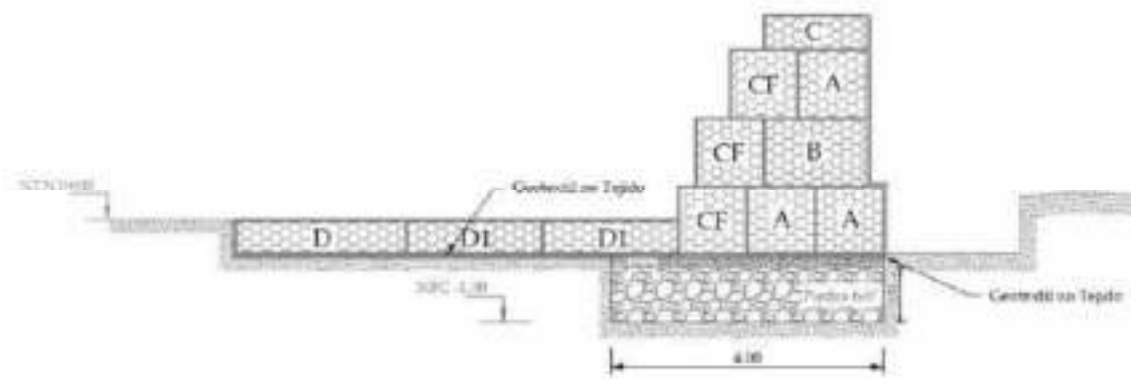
Detalle de cimentación y colocación de geotextil no tejido entre gaviones y terreno.
